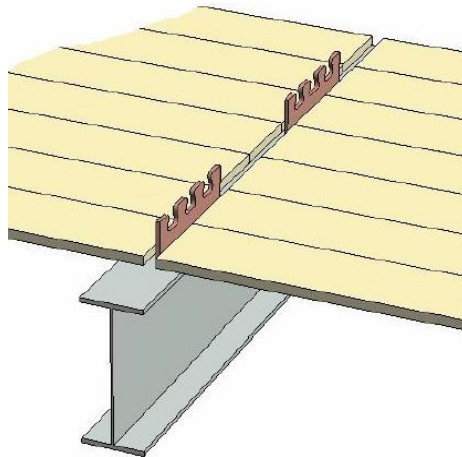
Conector Crestbond com pré-laje de concreto. (Veríssimo, 2007)
